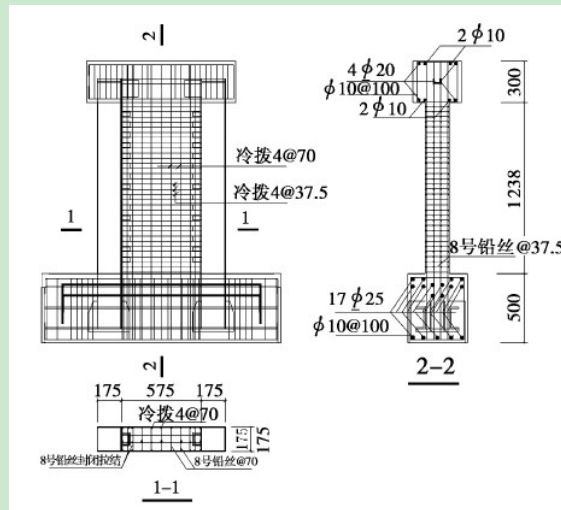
王敏^[76]试验方钢管混凝土边框柱剪力墙配筋详图 (单位: mm)
